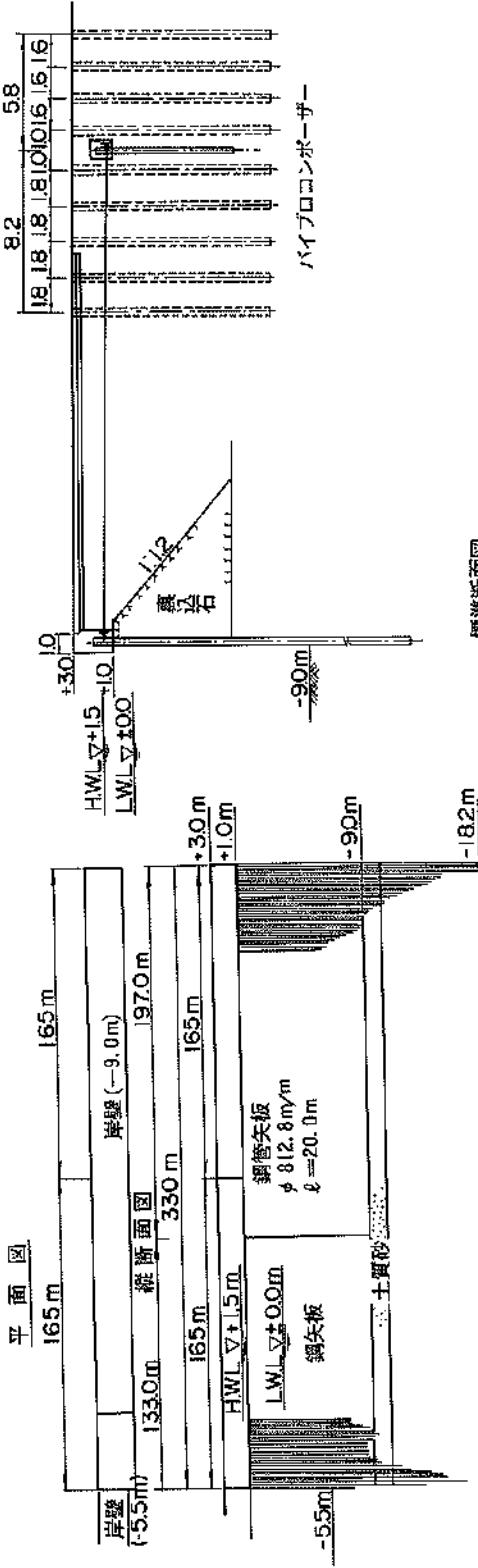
平面図・縦断面図・標準断面図(第1埠頭地区, ③東側岸壁(-5.5m))
